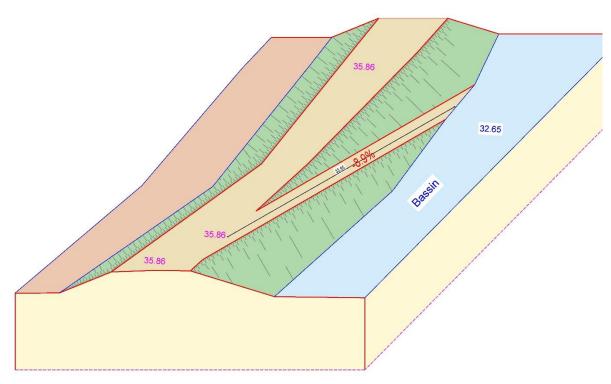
Plan et coupe de la rampe d'accès au bassin de compensation
